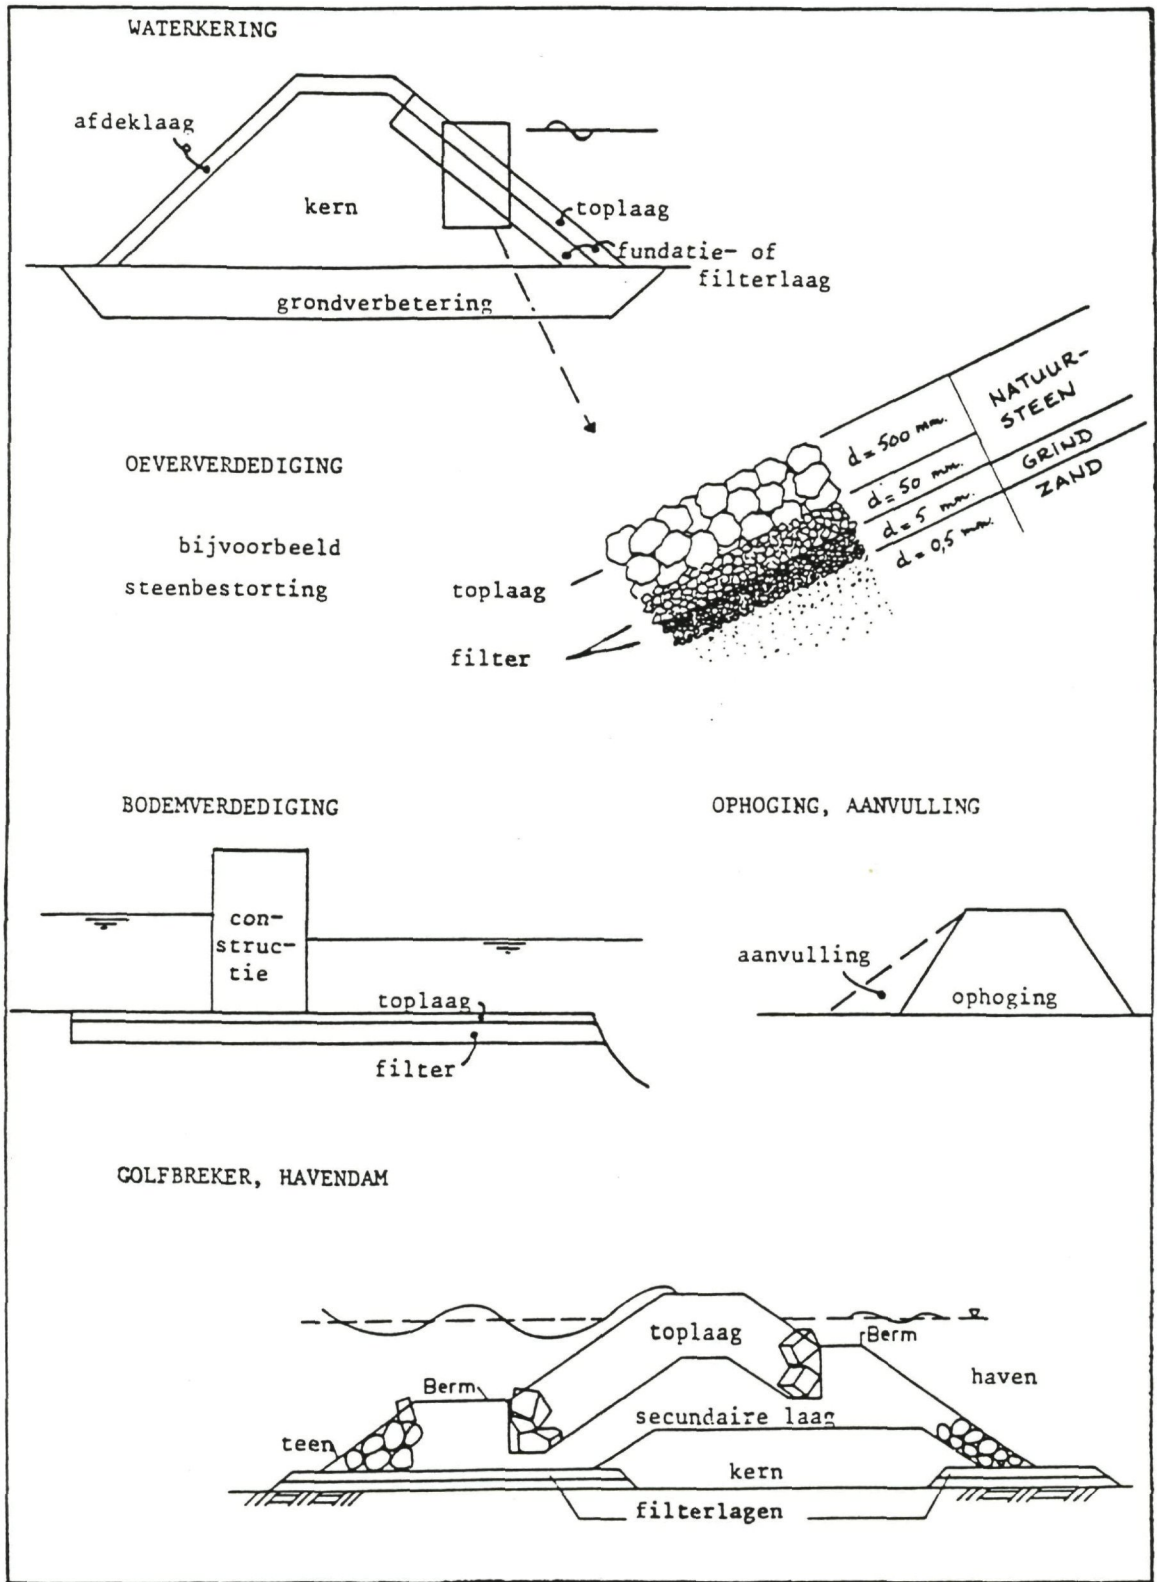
Doorsneden van constructies met hoofdconstructieonderdelen.
